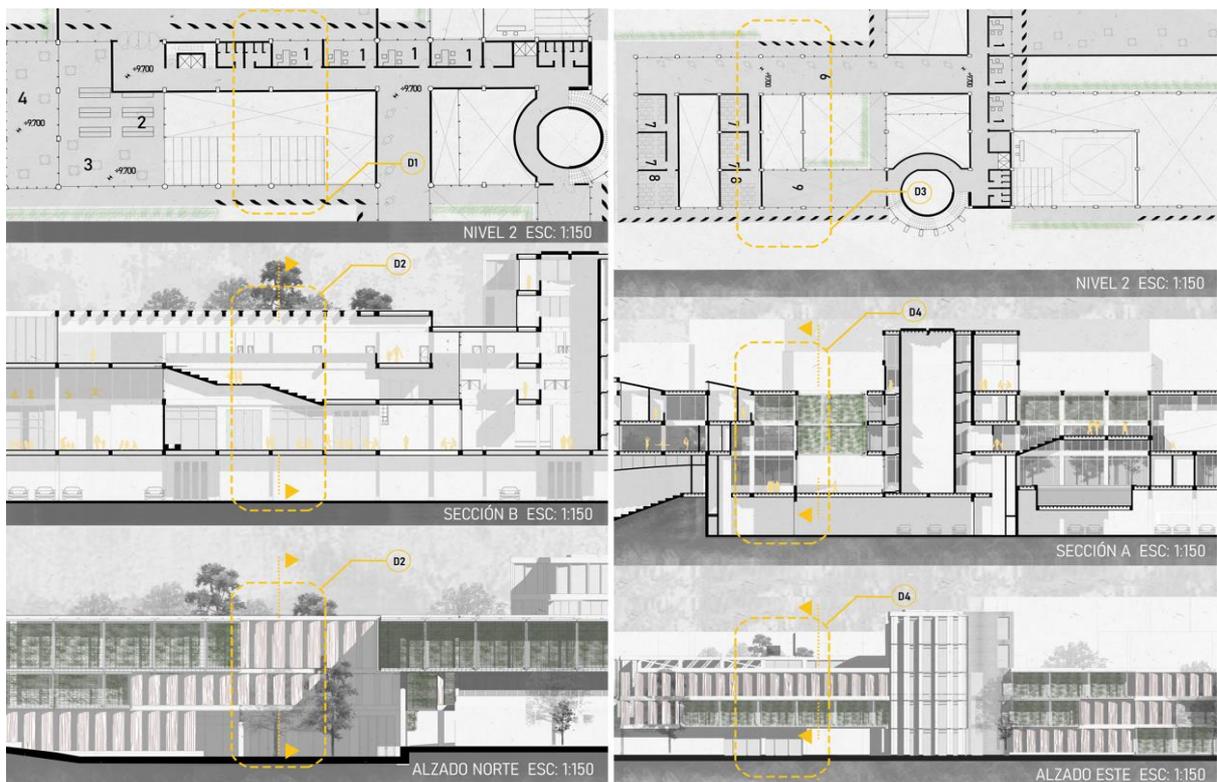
Ubicación de detalles constructivos y cortes por fachada. Elaboración propia.
